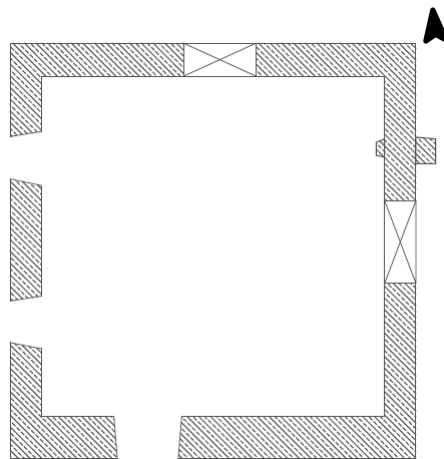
Planta do Hospital do Paço de Vilar de Perdizes (adaptada de original).
